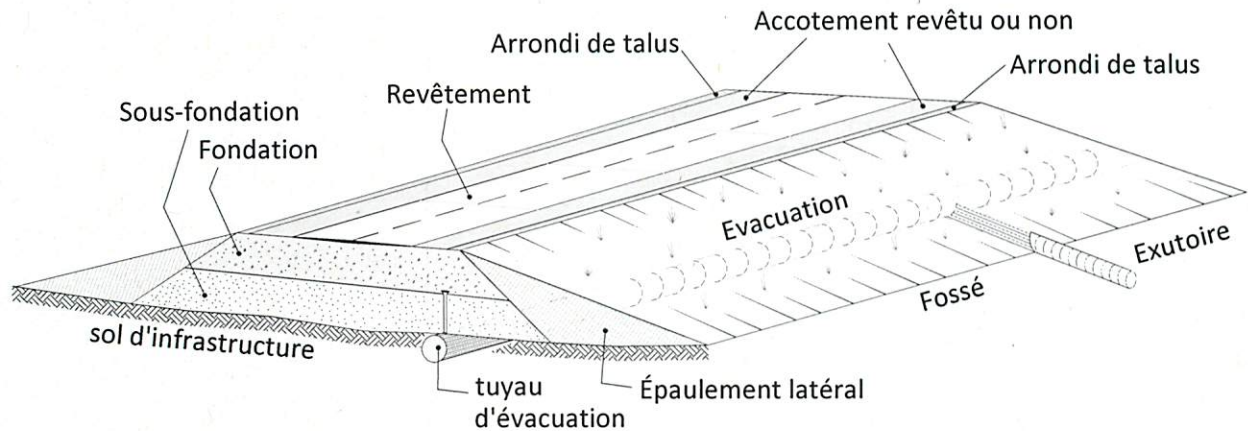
Définition des éléments d'un système de drainage dans la structure de chaussée.
